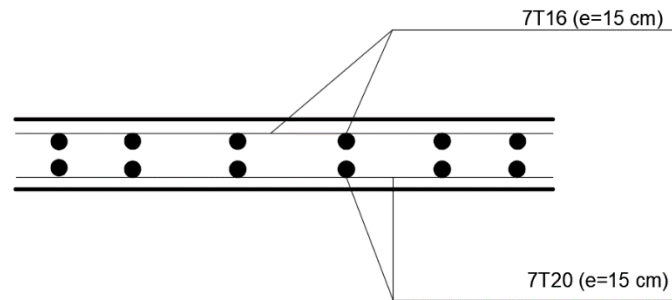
Schéma de ferrailage de la dalle du radier pour 1 ml
